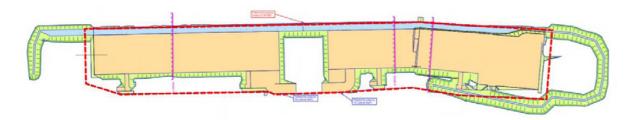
Plan d'emprise du périmètre de palplanche à fonction hydraulique (source : GSE)
